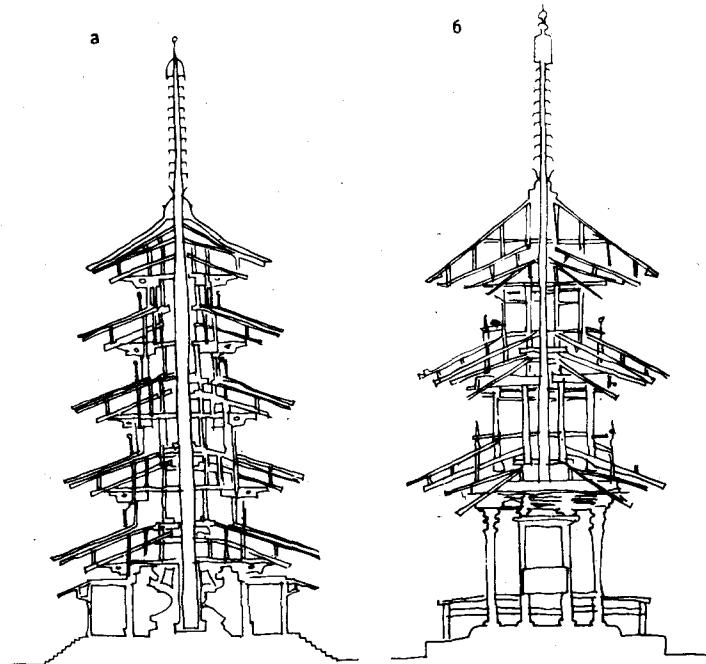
а – пятиэтажное здание храма Хорюдзи в г. Нара; б – трехэтажное здание храма в Токакова-ши, Айти
